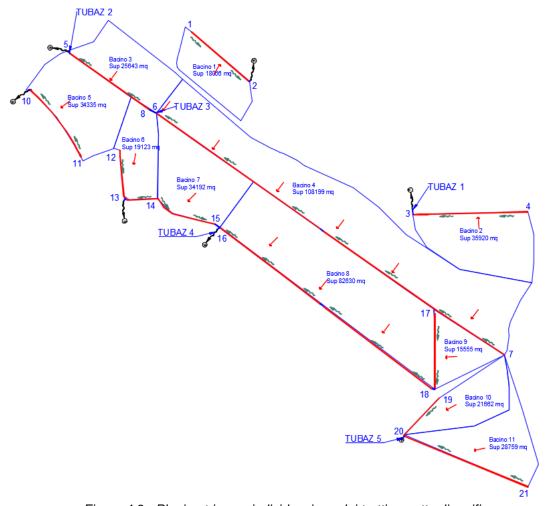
Planimetrie con individuazione dei tratti oggetto di verifica
